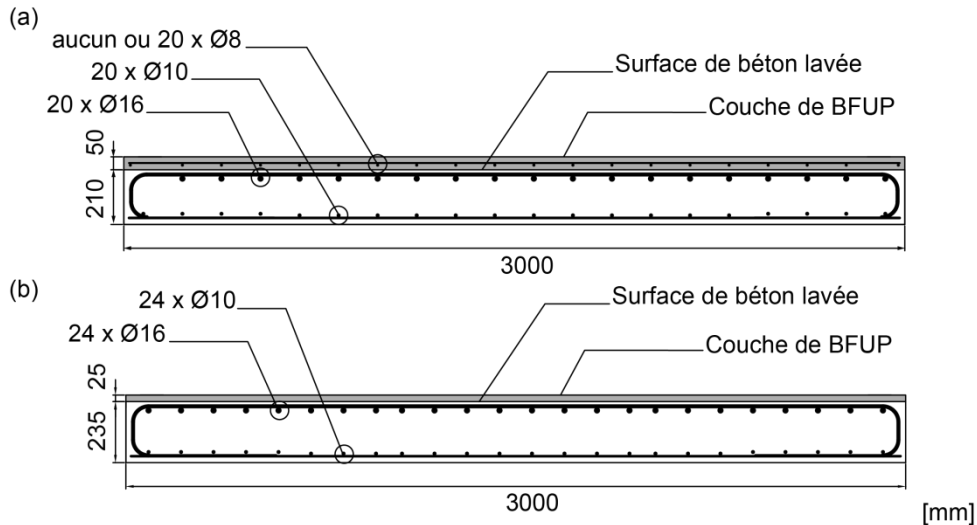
Géométrie et plan d'armature : (a) dalles PBM1 à 3; (b) dalle PBM4
